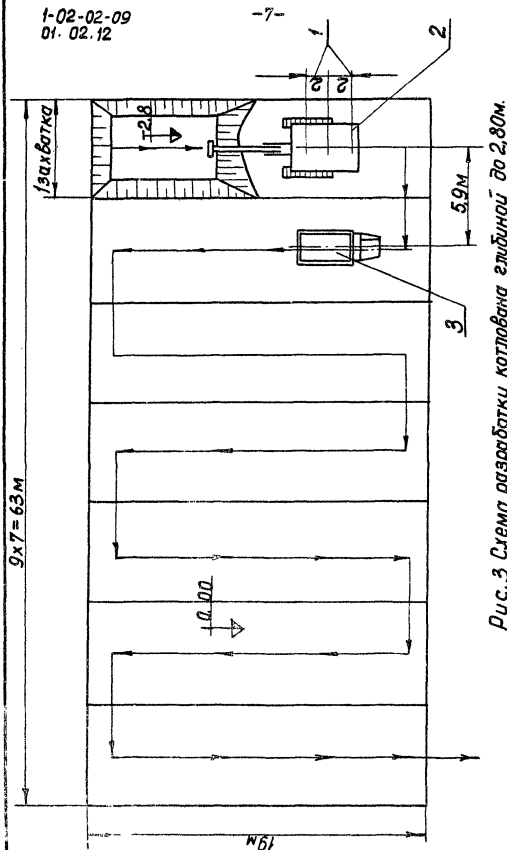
Схема разработки котлована глубиной до 2,80м.
